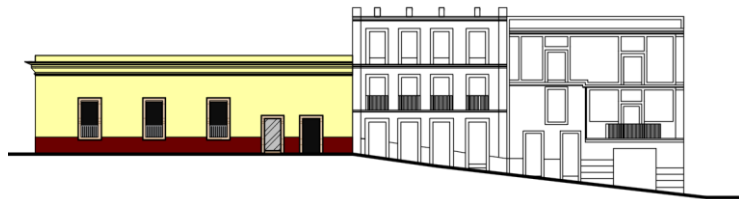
Colores y acabados actuales Fachada Lateral Casa Condal de Pérez Gálvez. Elaboración Propia.
